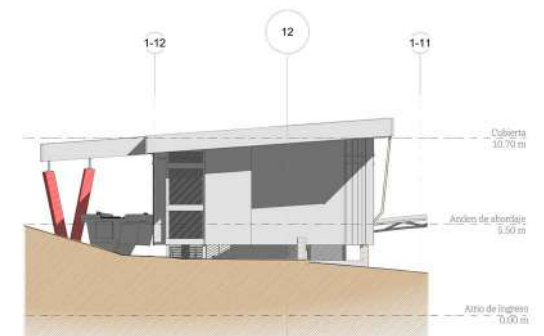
Levantamientos Norte y Sur del Andén de Abordaje.
